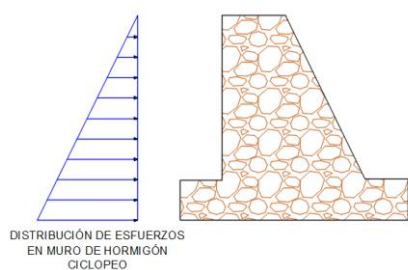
Esfuerzos en muro de Hormigón ciclópeo.
